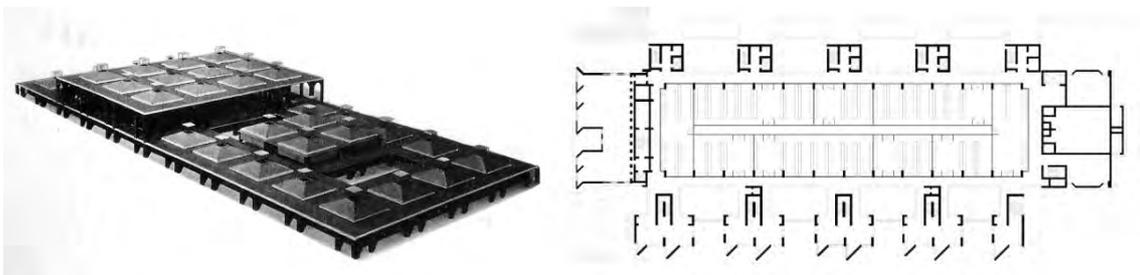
e 63 | As *células* iguais em Trenton (malha) e a planta de Salk (figura)
